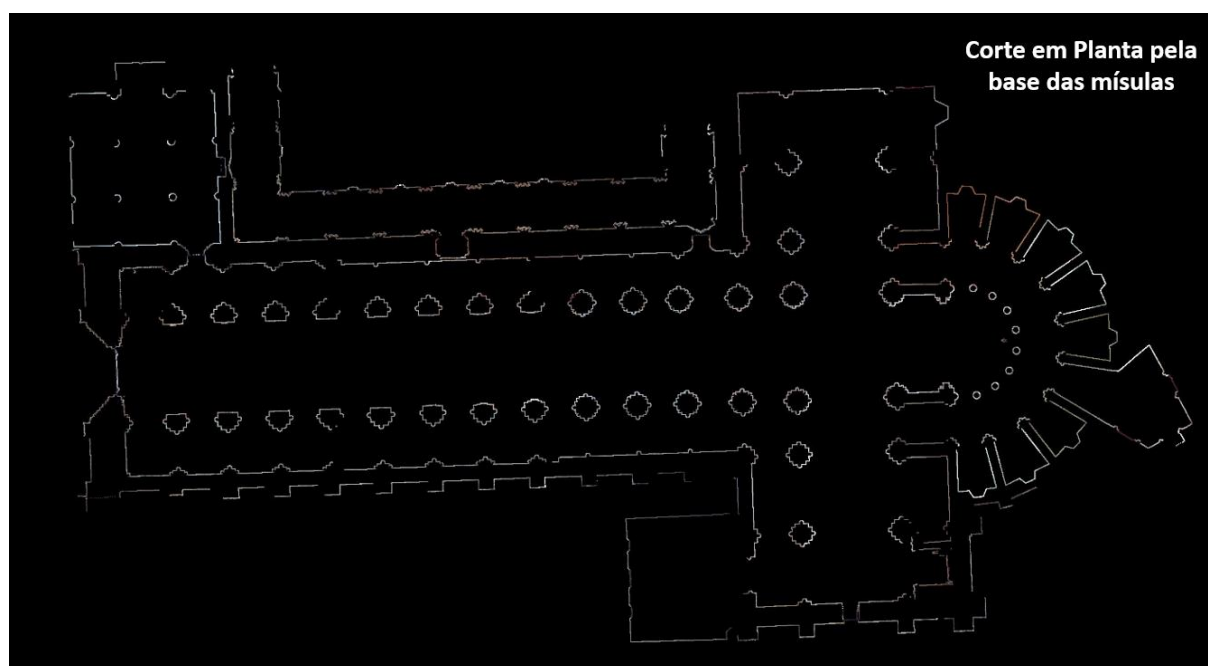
Corte em planta pela base das mísulas piramidais dos pilares da Igreja do Mosteiro de Alcobaça.
